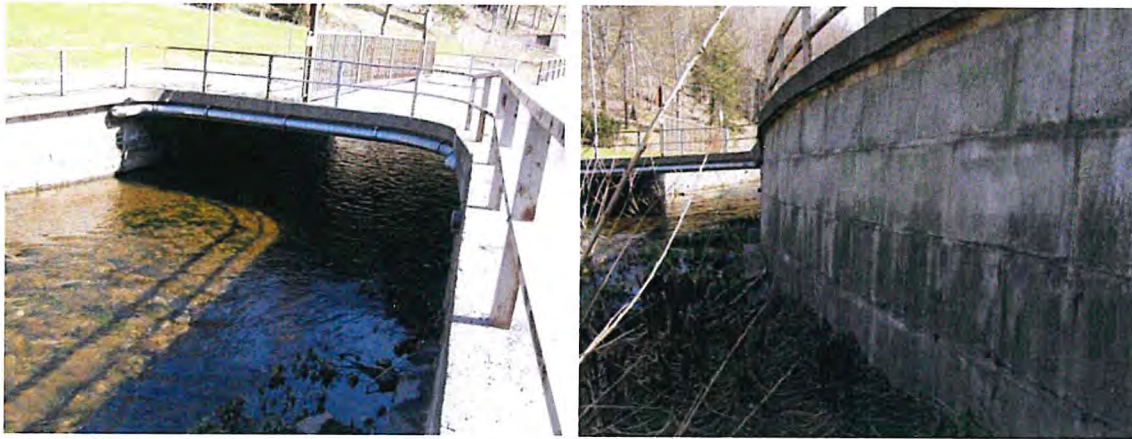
Brücke der ehemaligen Werkszufahrt Foto 18: BW 6 (Stützwand)
